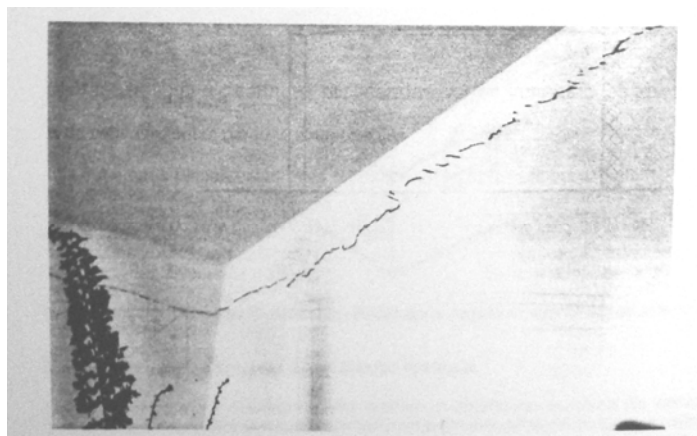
Parede com fissuras inclinadas, em forma de escama, evidenciando a dilatação térmica da laje de cobertura (Fonte: THOMAZ)
